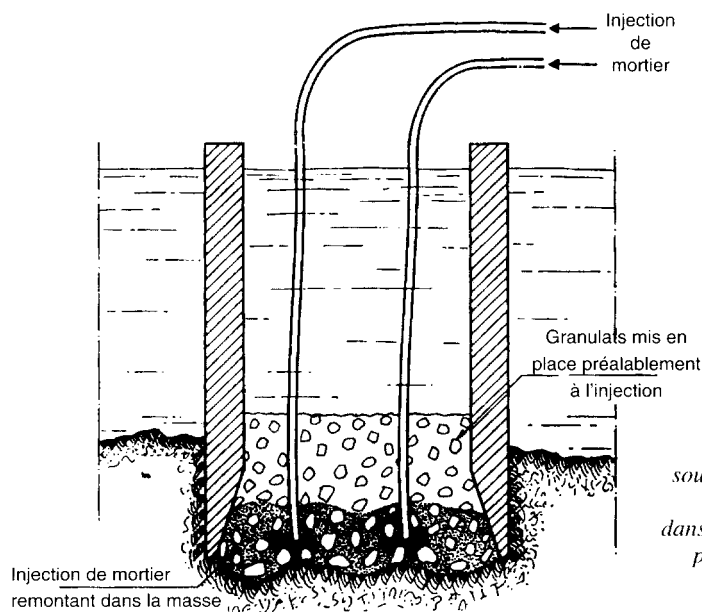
Bétonnage sous l'eau du fond d'un caisson par injection de mortier dans une masse de gros granulats préalablement mis en place (béton Colcrete).
